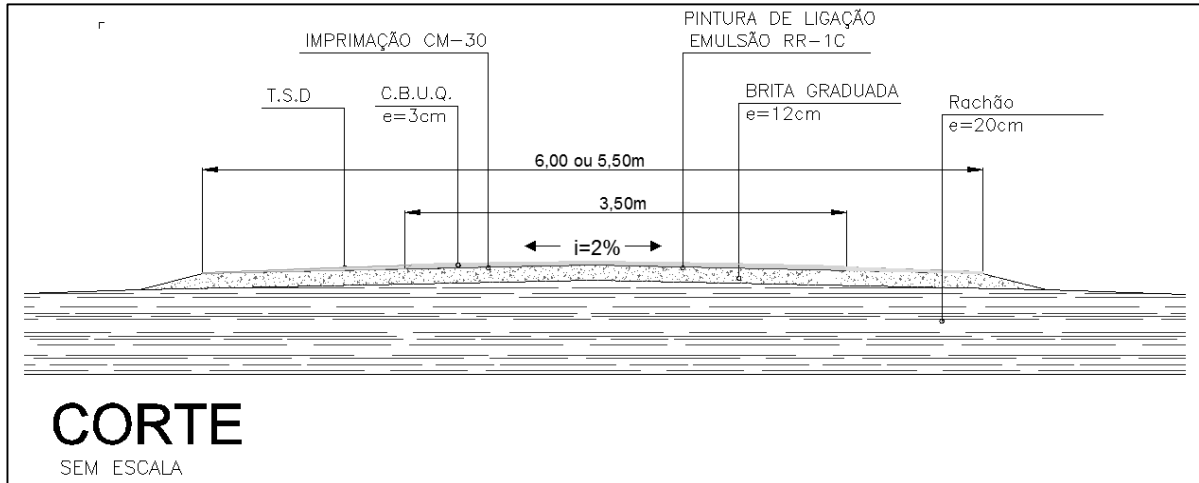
(A) – Seção do Pavimento utilizada entre 2005 e 2012.
